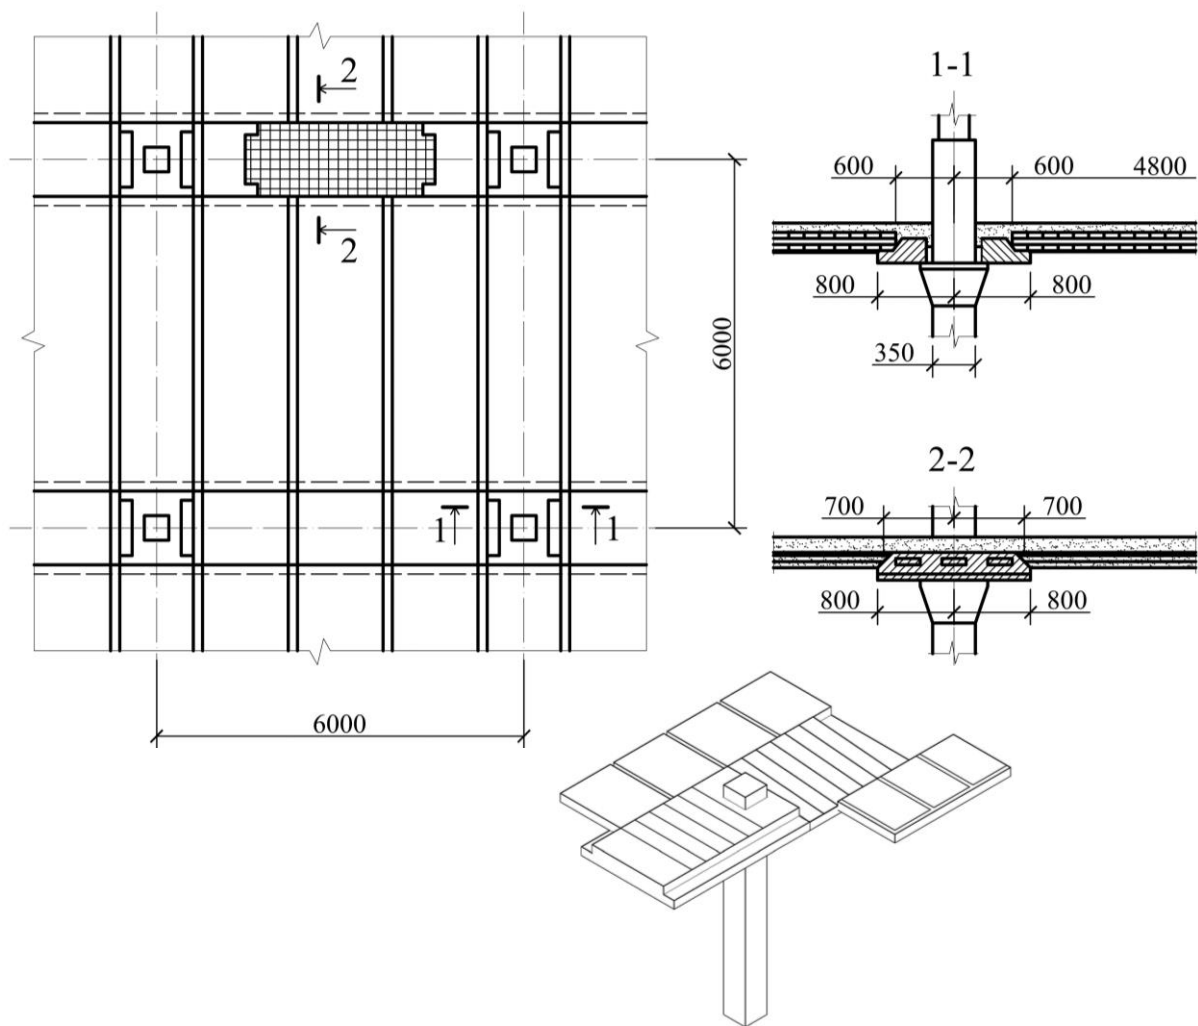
Фрагмент збірно-монолітного безбалкового перекриття
